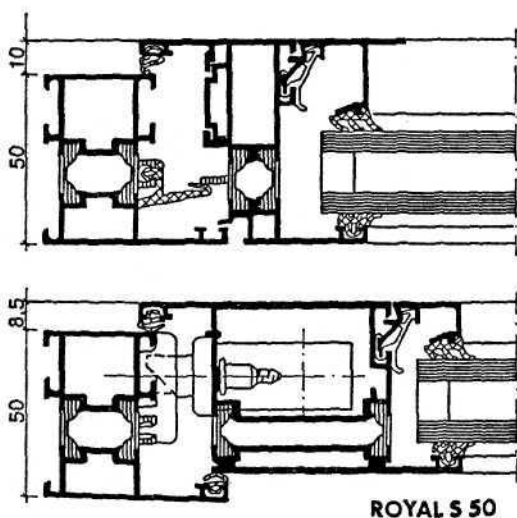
Алюминиевый профиль БАМО-SCHUCO
